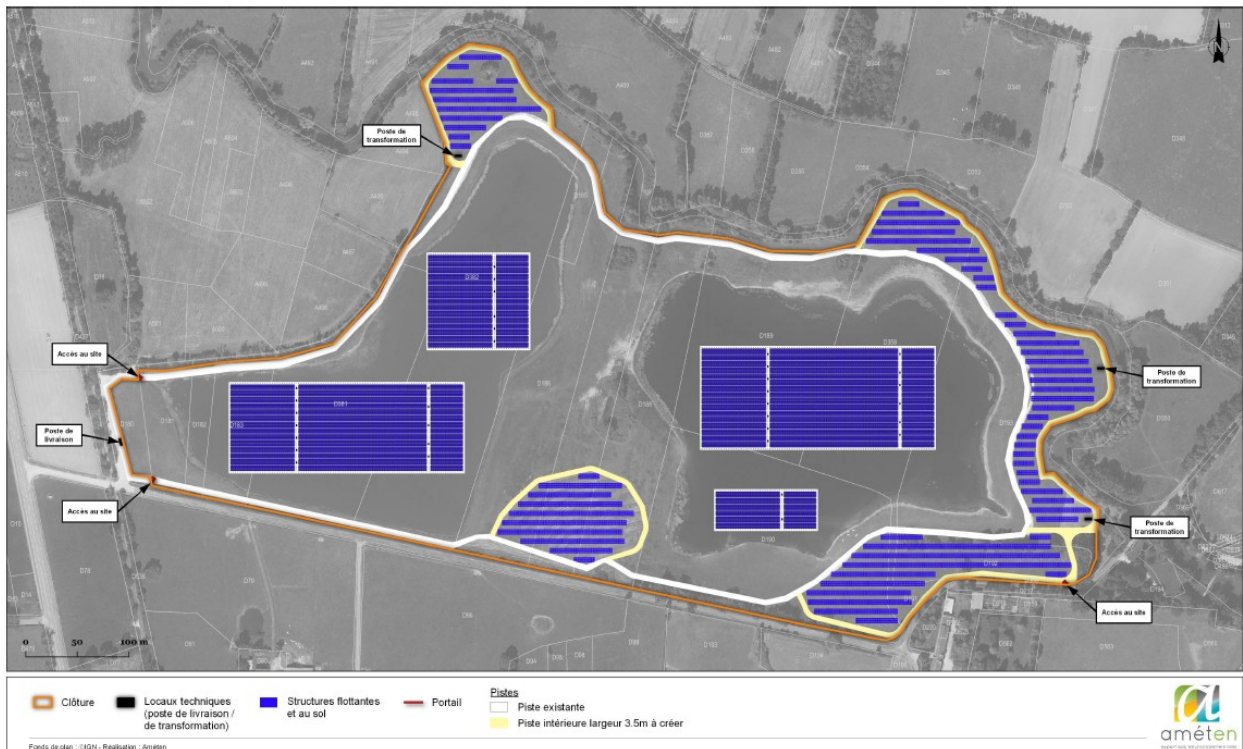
Plan d'implantation du projet d'environ 28,9 ha (source : étude d'impact)
